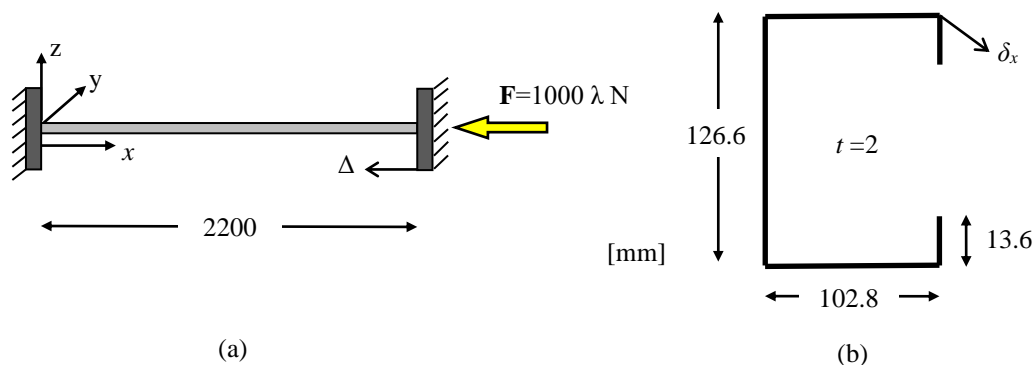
Coluna em C bi-encastrada: (a) vista geral e carregamento, e (b) dimensões da secção (linha média).
